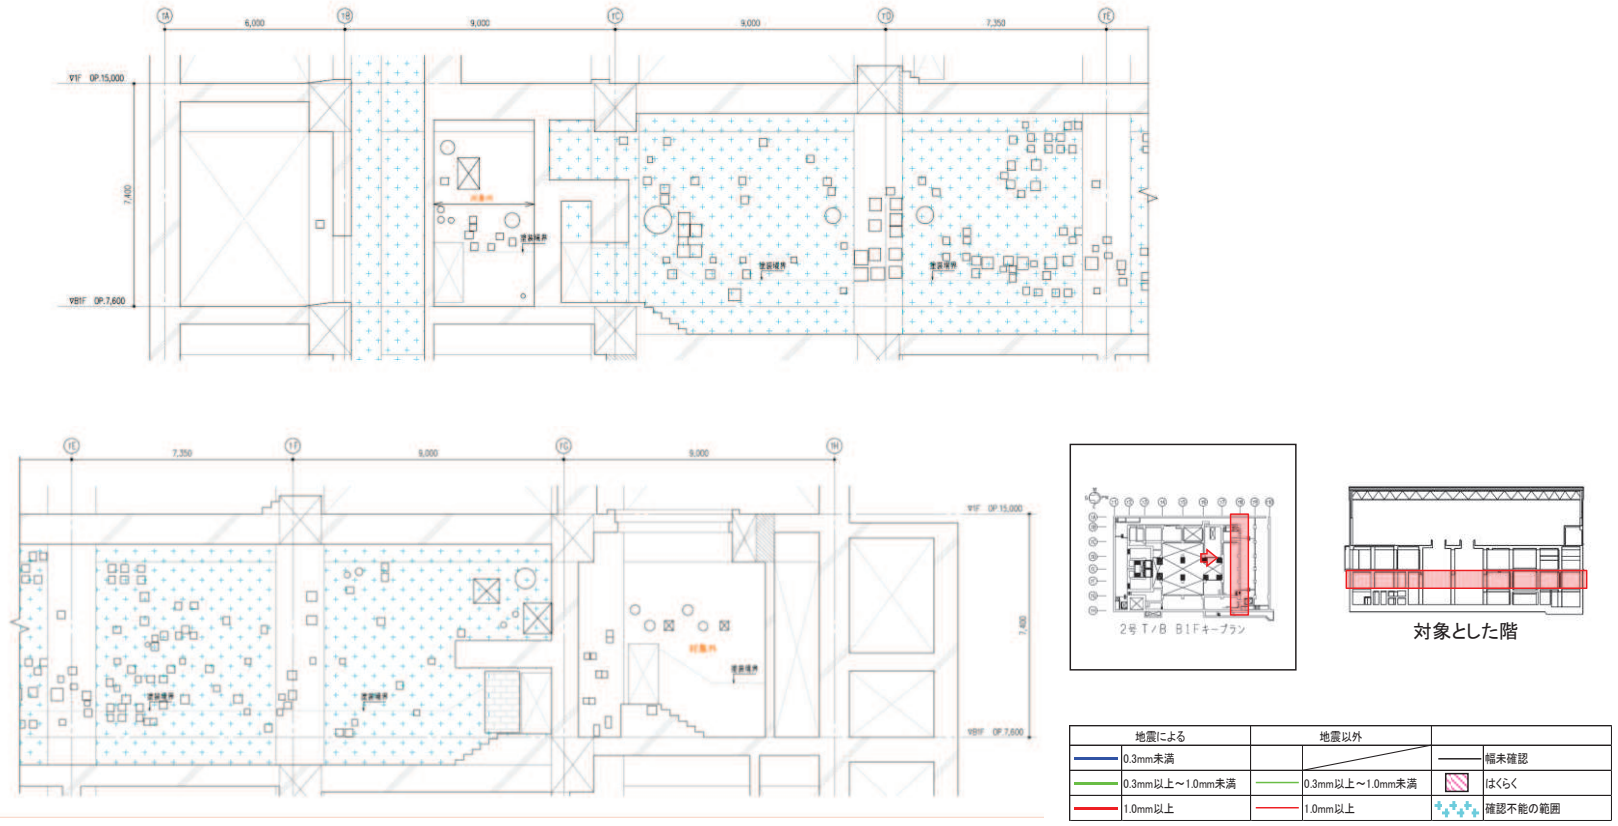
タービン建屋のひび割れ分布 耐震壁 (24) 地下 1 階 T8 通り
